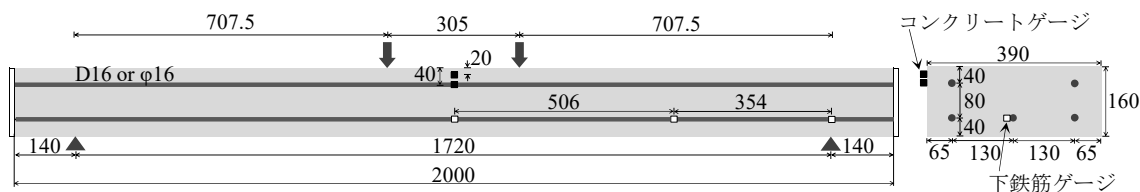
RCはり供試体の形状寸法, 配筋状況, ひずみゲージ設置位置
